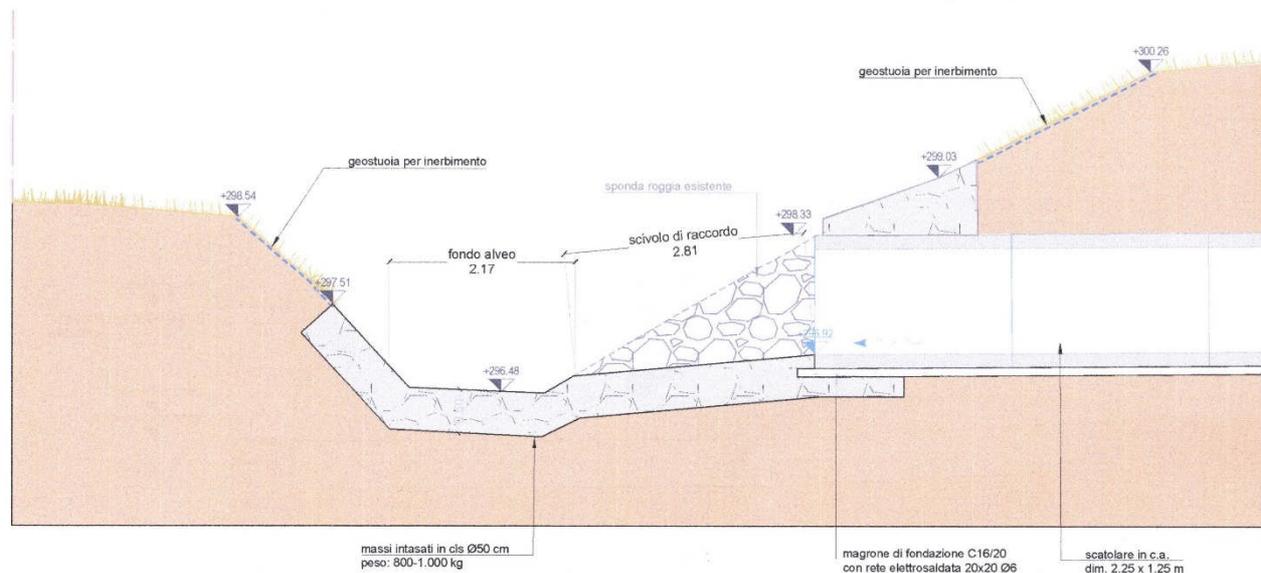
Progetto Rev. 09/2023 - Estratto sez. A-A manufatto di sbocco
